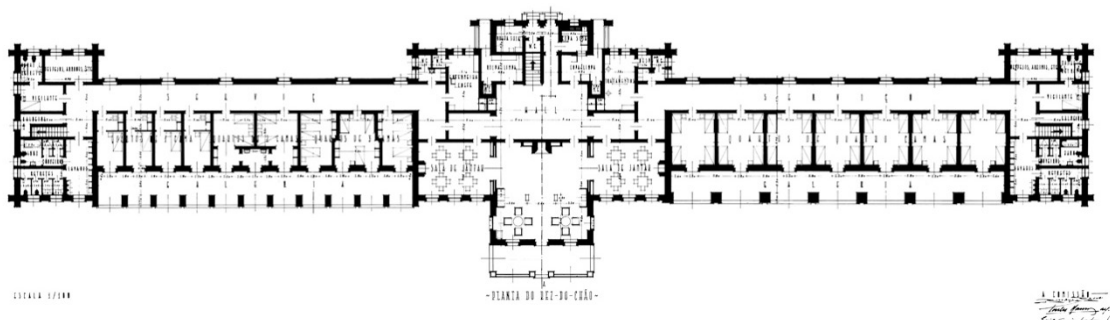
Planta de Asilo da Leprosaria Rovisco Pais.
